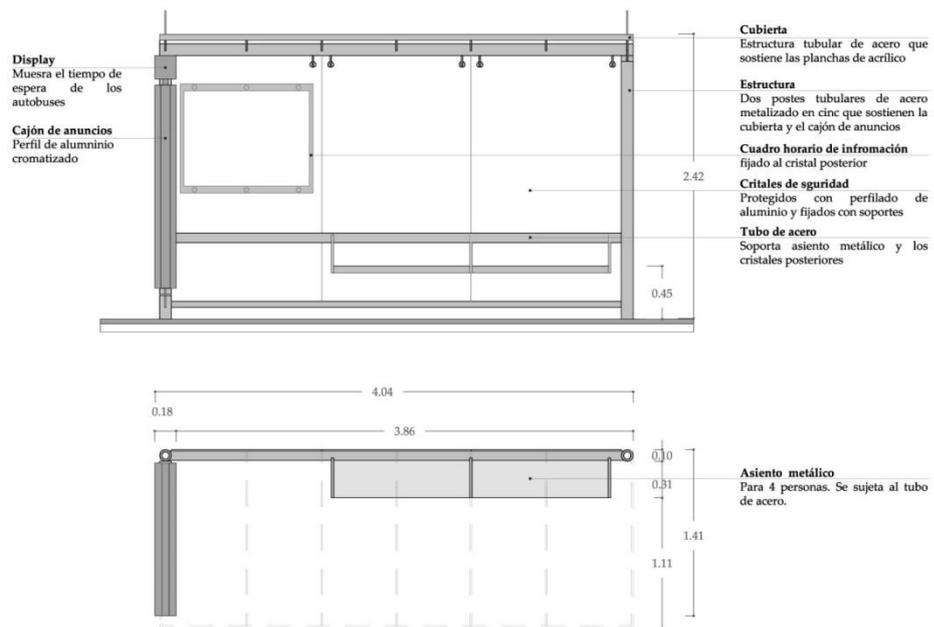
Alzado y planta marquesina modelo Foster. Dibujos de la autora
